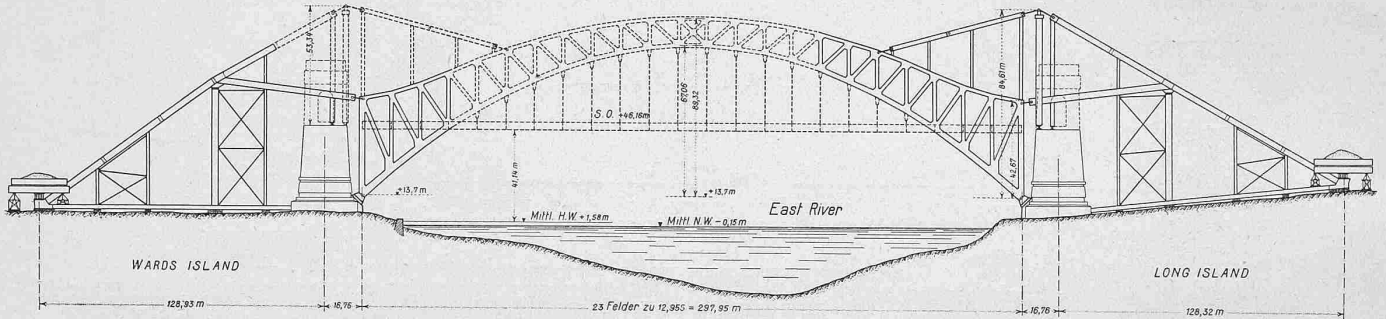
Darstellung des Montage-Vorgangs beim Bau der Hell-Gate-Brücke in New York. — Masstab 1 : 3000.
